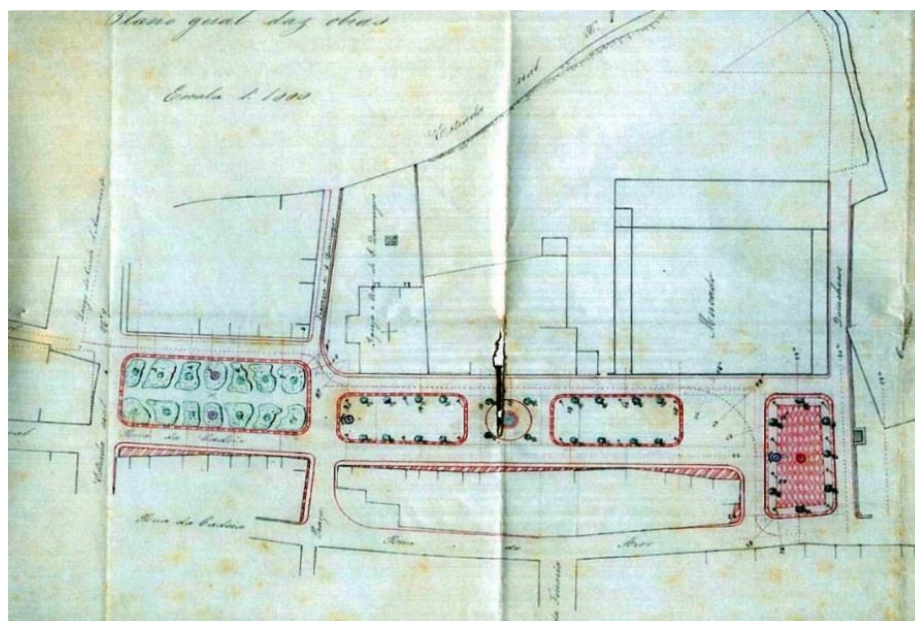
Planta de remodelação das praças Luís de Camões e Lopo Vaz, 1891 [8]
